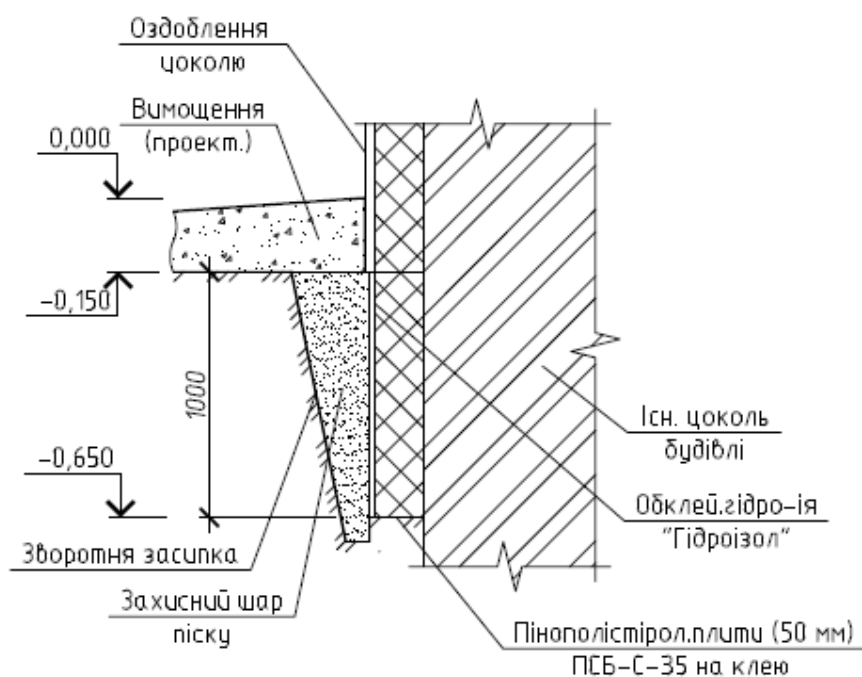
Прийнята конструкція утеплення фундаменту будівлі.
